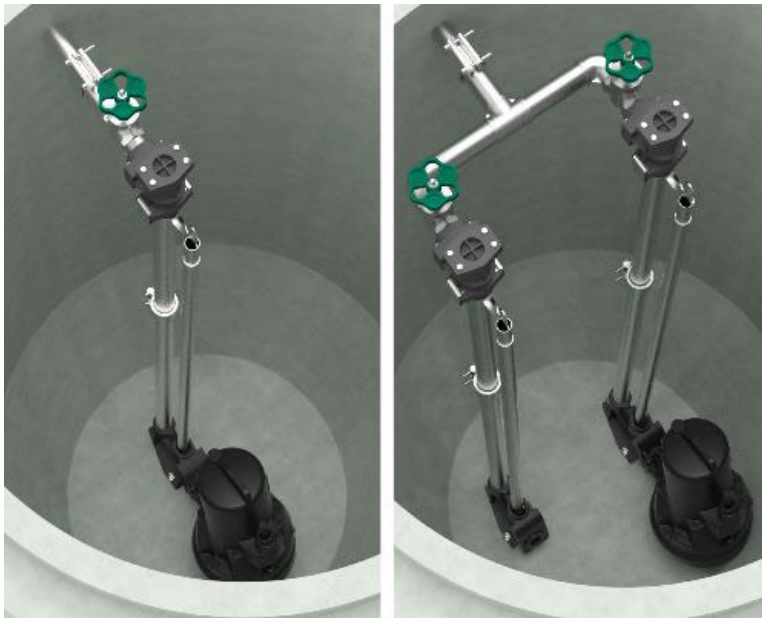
Sanierung des Schachtinnenlebens von Betonschächten: Vormontierte Einbausets erleichtern den Austausch alter Einbauten.
